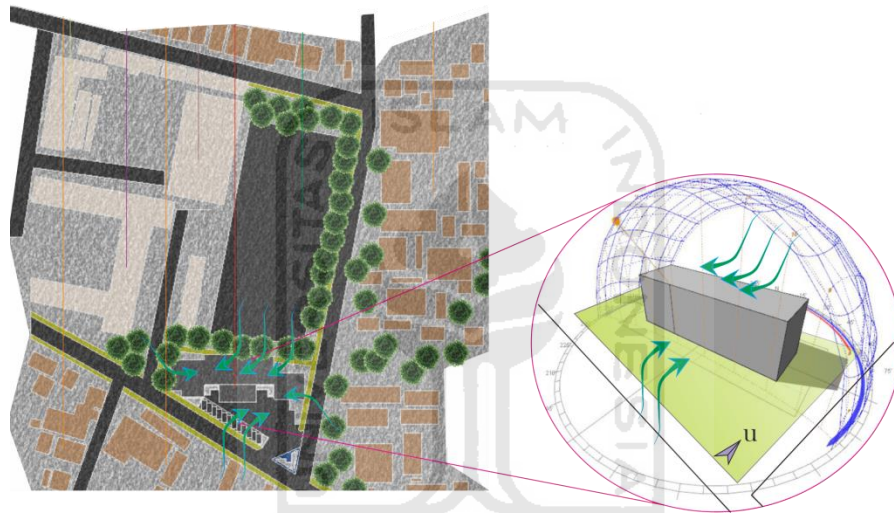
Jatuh Bayangan Pada Bulan Juni
